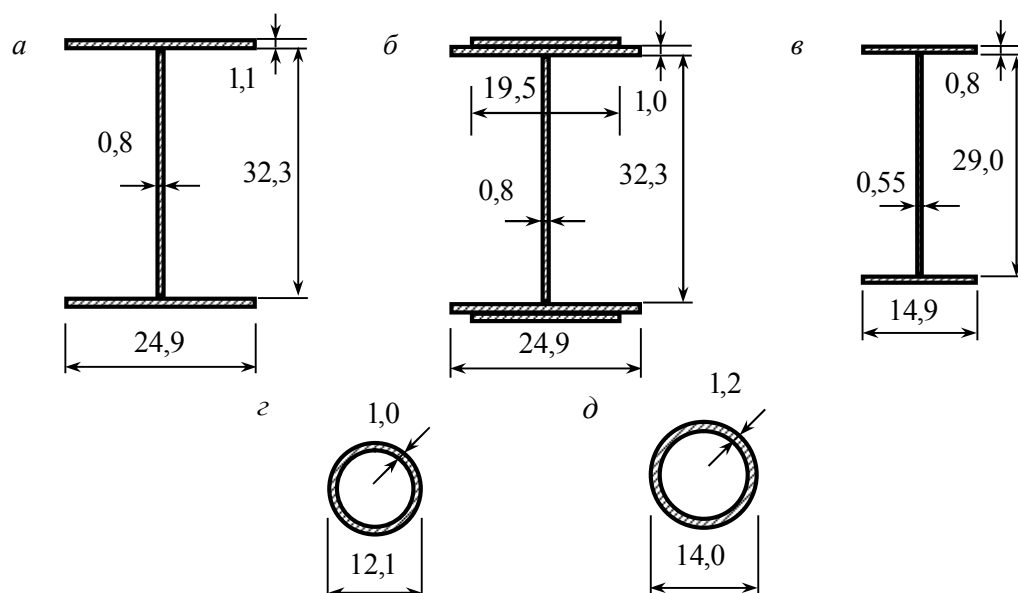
Поперечные сечения элементов конструкции покрытия (все размеры указаны в см); верхняя балка (а); верхняя балка с усилением полок (б); надколонник (в); затяжка (г); подкос (д)
